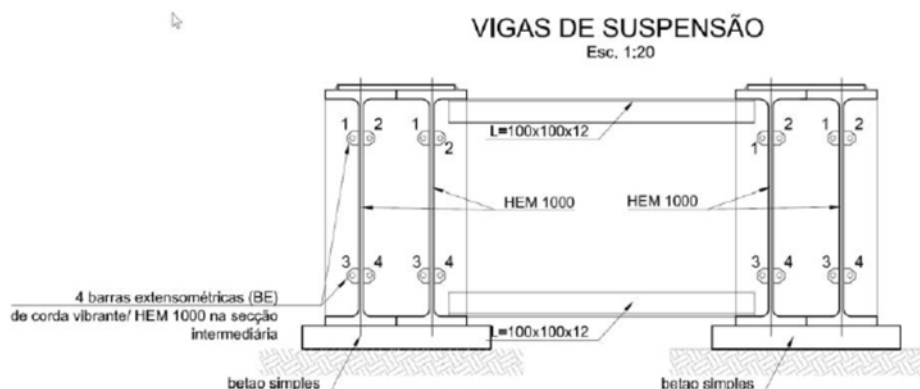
Instrumentação nas vigas de aço (suspensão de via) do emboquilhamento ponte
